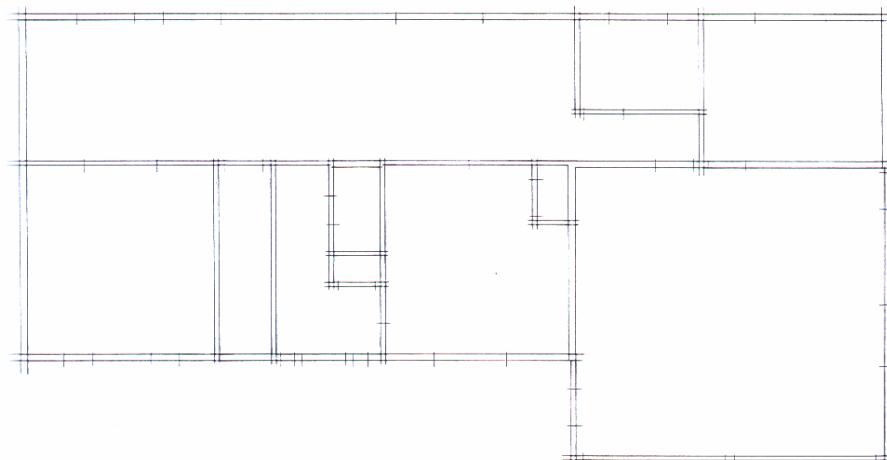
المسقط الأفقي الناتج عن مستوى القطع الأفقي المار بالمبني
